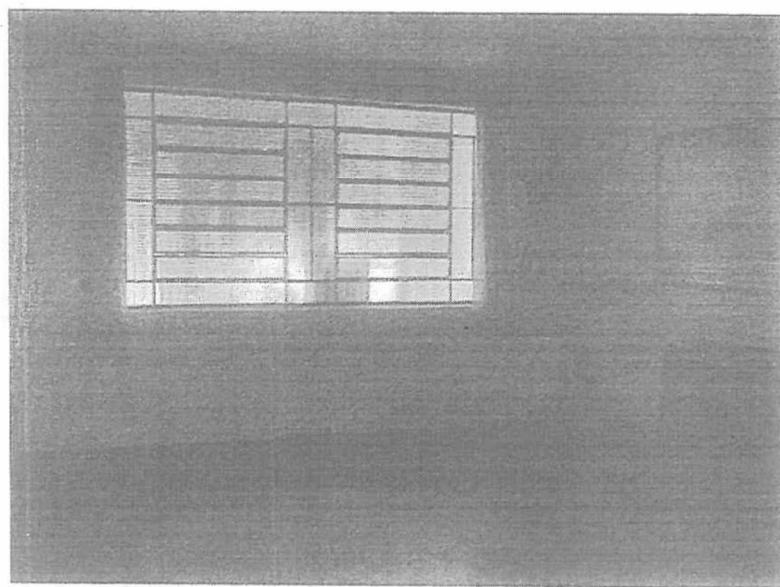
Aspecto da estrutura de madeira existente na área externa.
